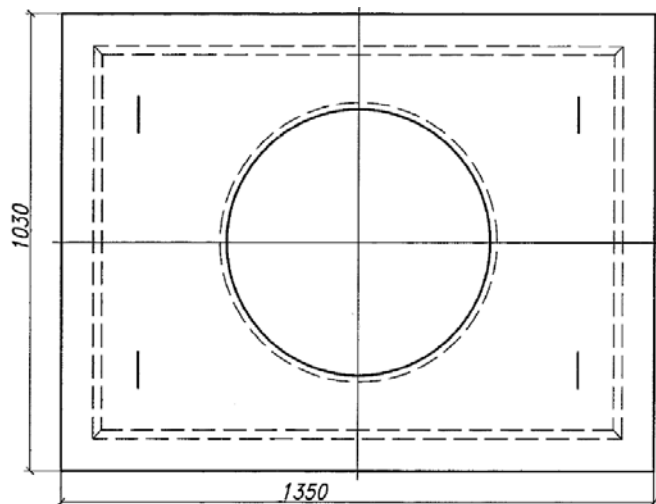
Размеры плиты перекрытия (вид сверху).
